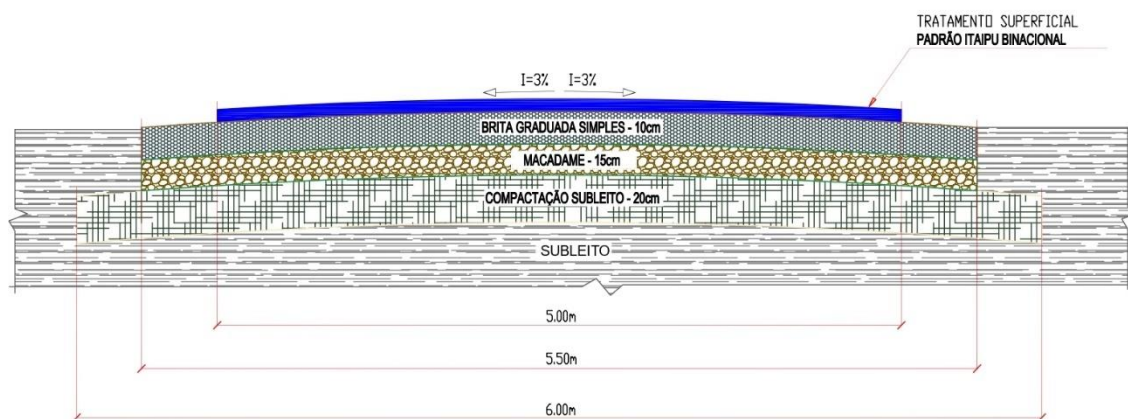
Exemplificação da declividade, base e sub-base e espessura e largura das camadas do pavimento.
